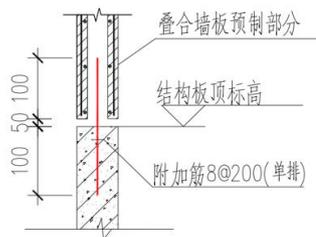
预制双面叠合填充墙竖向连接节点示意
